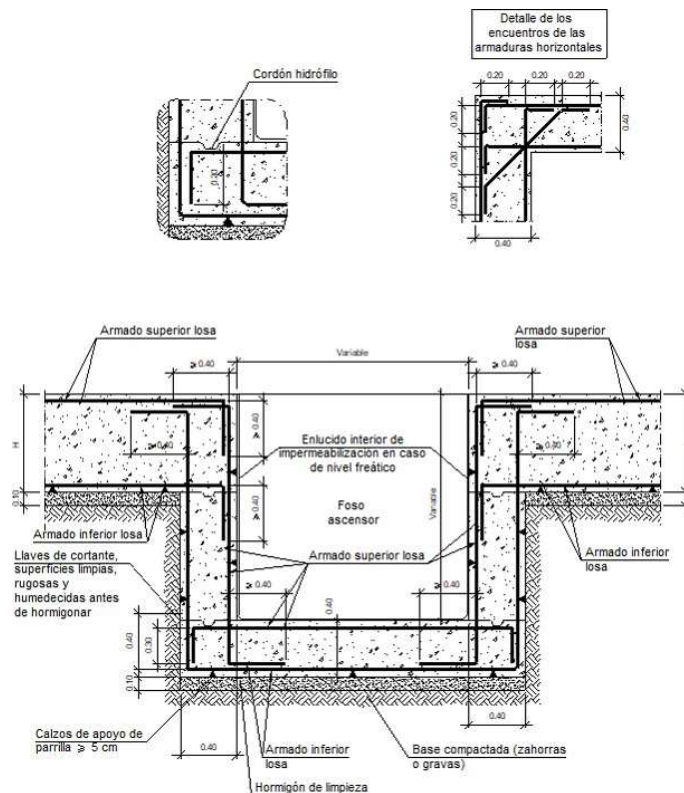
Detalle constructivo del foso para ascensores
